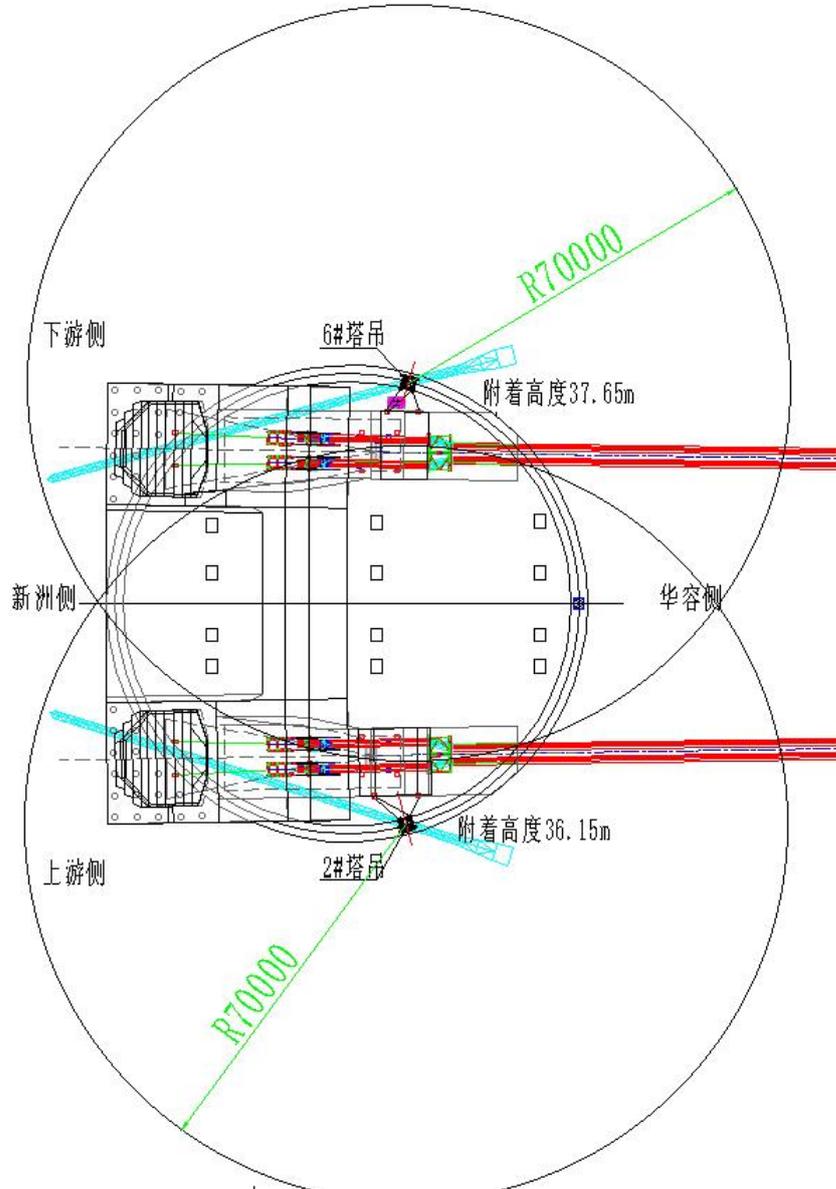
设备在安装部位平面布置图 (mm)
